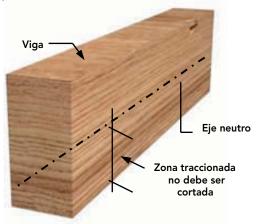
Las vigas no deben ser debilitadas con cortes en la zona traccionada.
